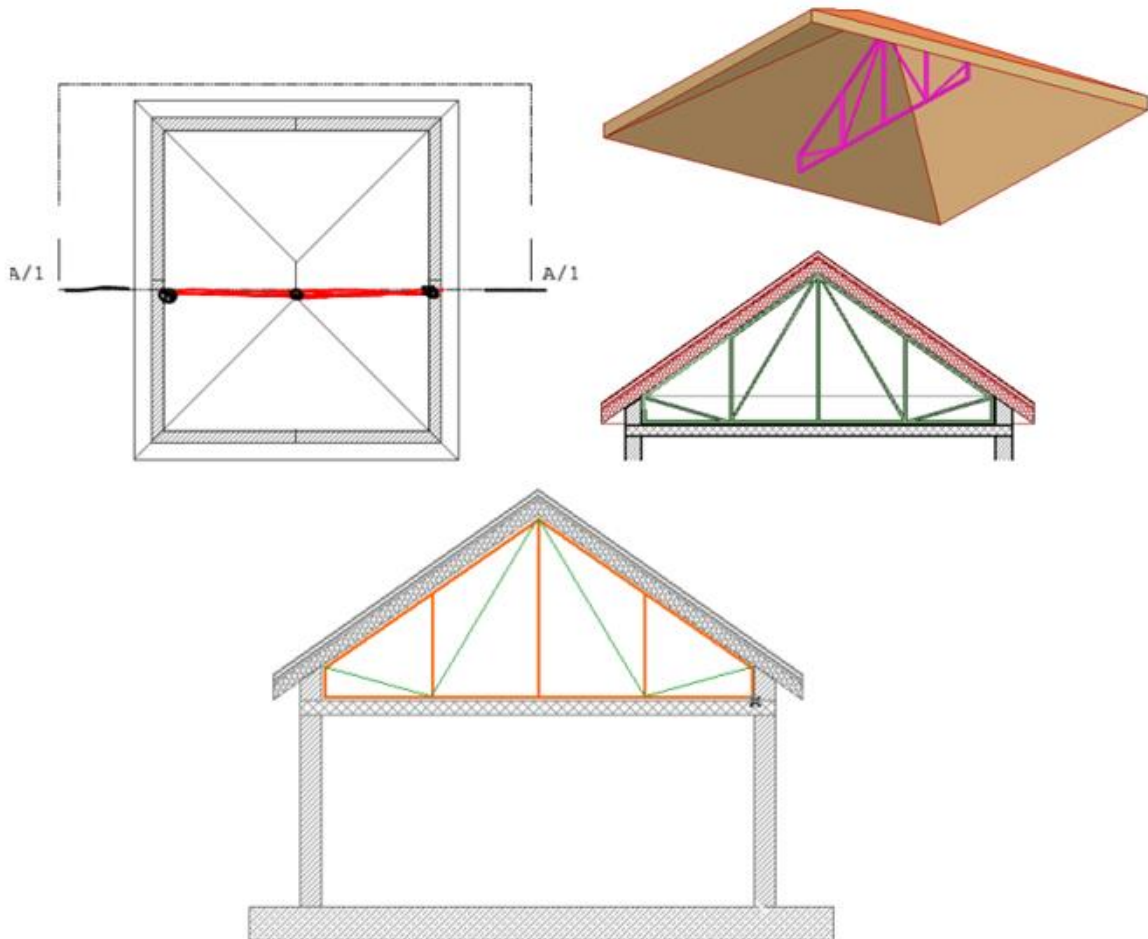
Створення ферм у вікнах розрізів/фасадів/ внутрішніх видів
